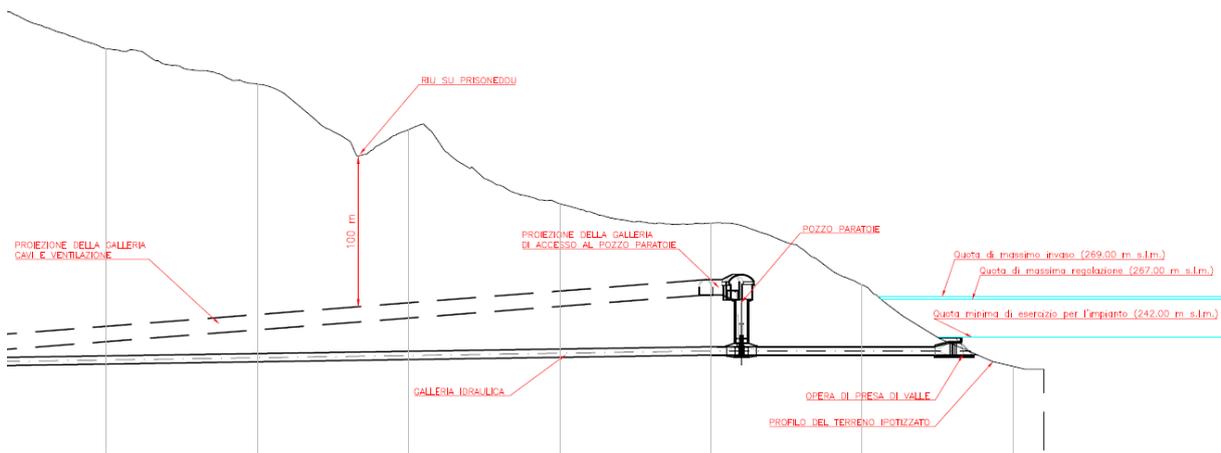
Profilo Longitudinale Galleria Idraulica
